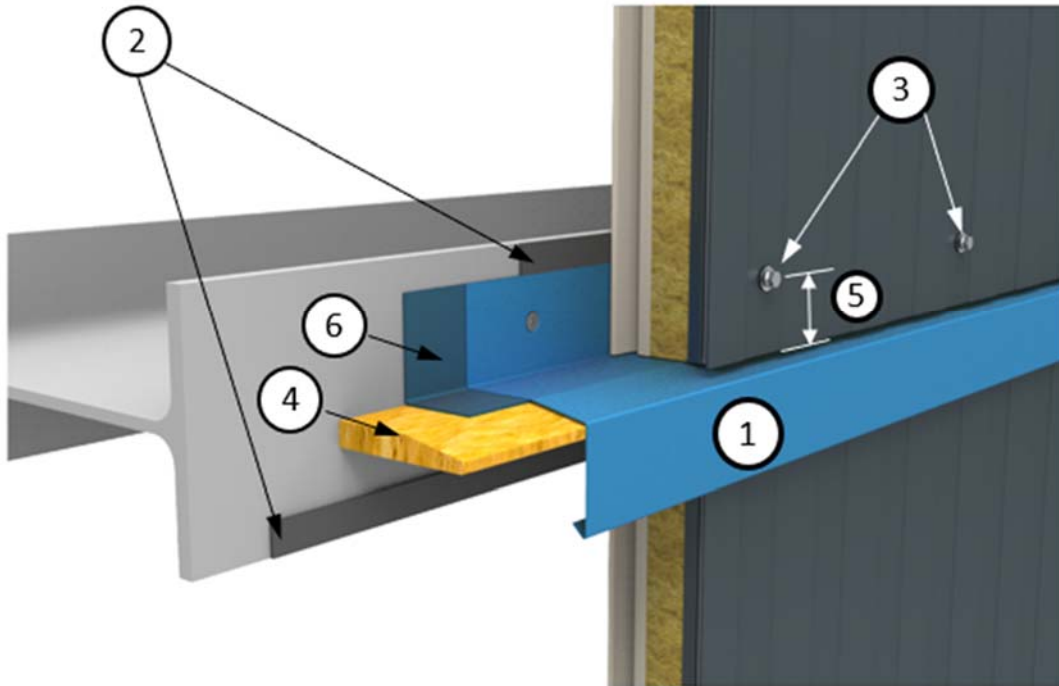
Ouverture – Pose horizontale (limité à une hauteur de bâtiment de 20 mm)
